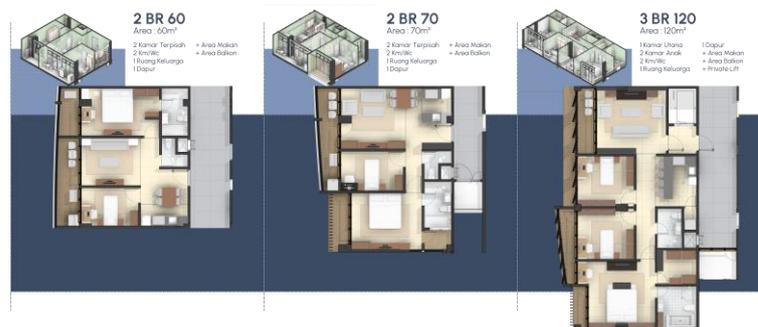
Konfigurasi Rencana Tower A, B dan C
